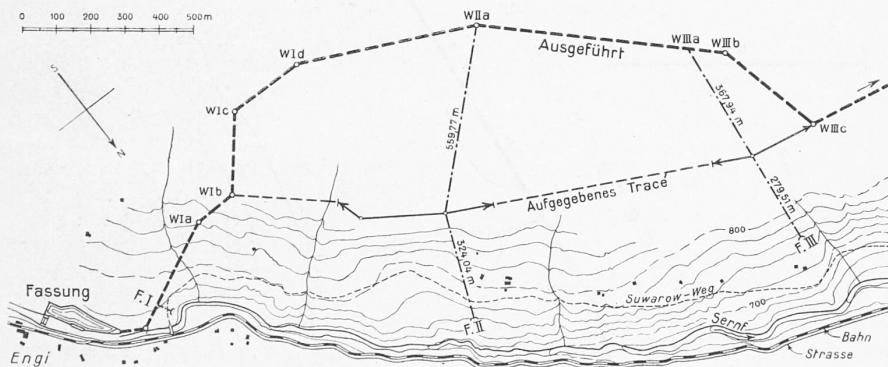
Lageplan der Stollenverlegung bergeinwärts. — Masstab 1 : 20 000.
